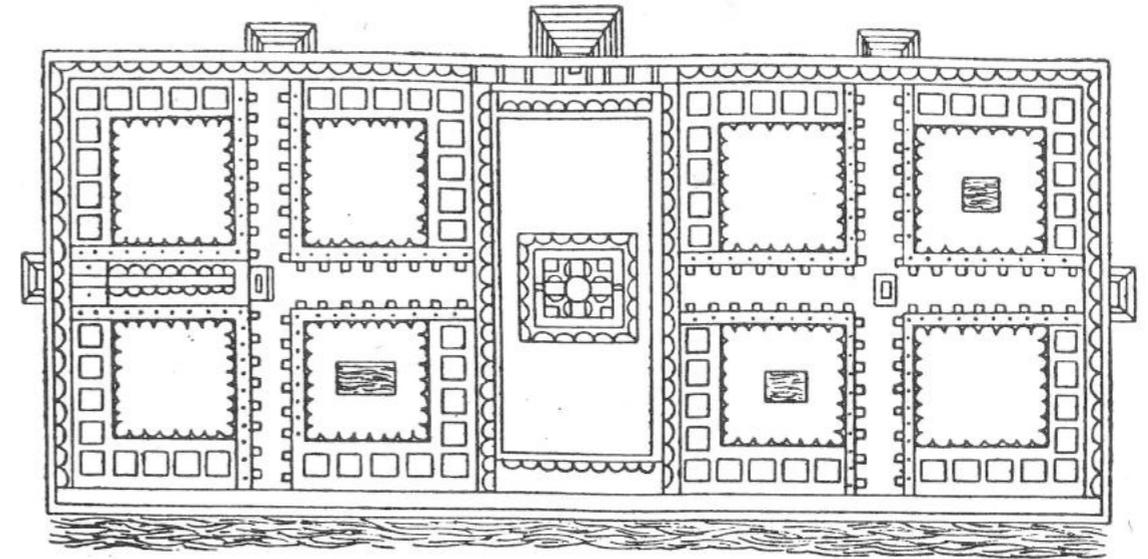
Grundriss des Ospedale Maggiore aus dem Architekturtraktat Filaretos (1460/64)
